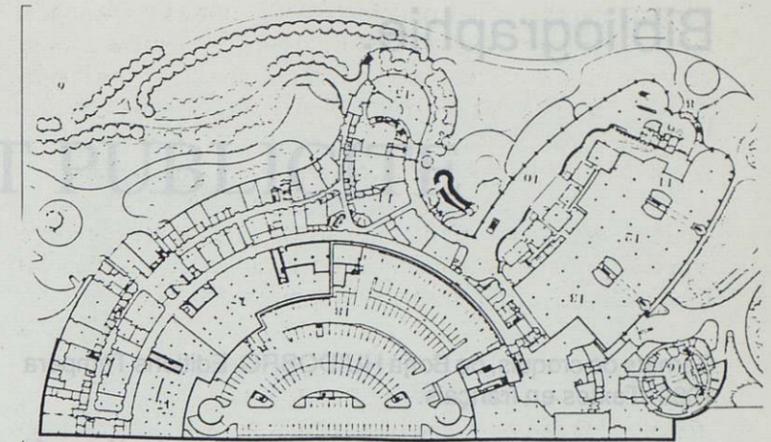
Plan au niveau du rez-de-chaussée du Musée.-
